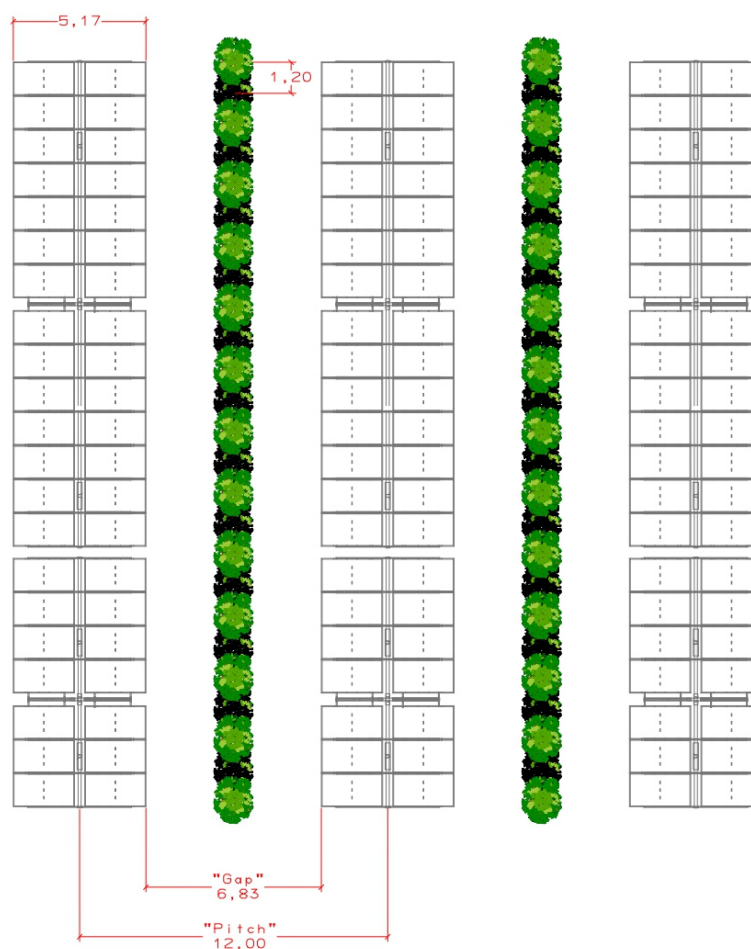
Dettaglio delle file del mandorleto tra le strutture della componente fotovoltaica
